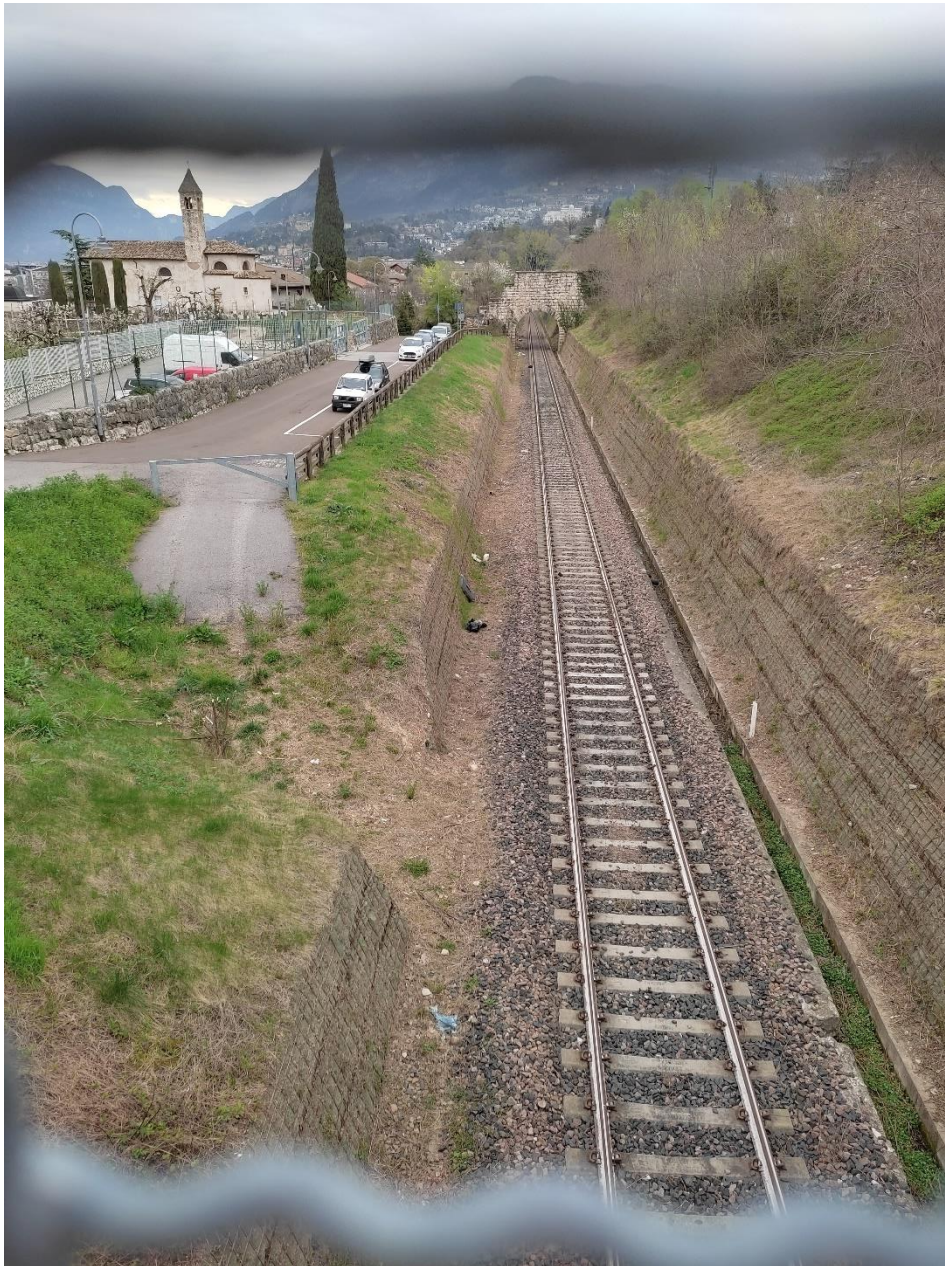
il tratto dal cavalcavia San Bartolameo pkm 143+063 al ponte canale pkm 143+201
